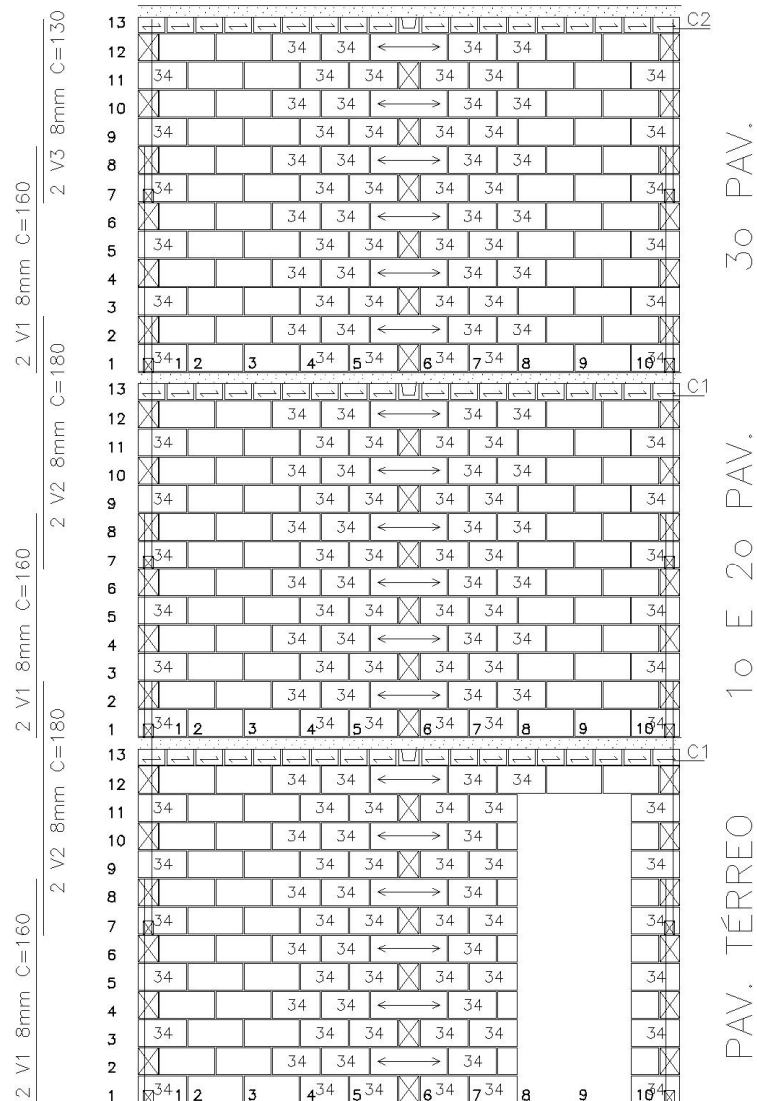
Elevação detalhada da parede onde ocorreu a intervenção. Fonte: Ilustração do autor.
